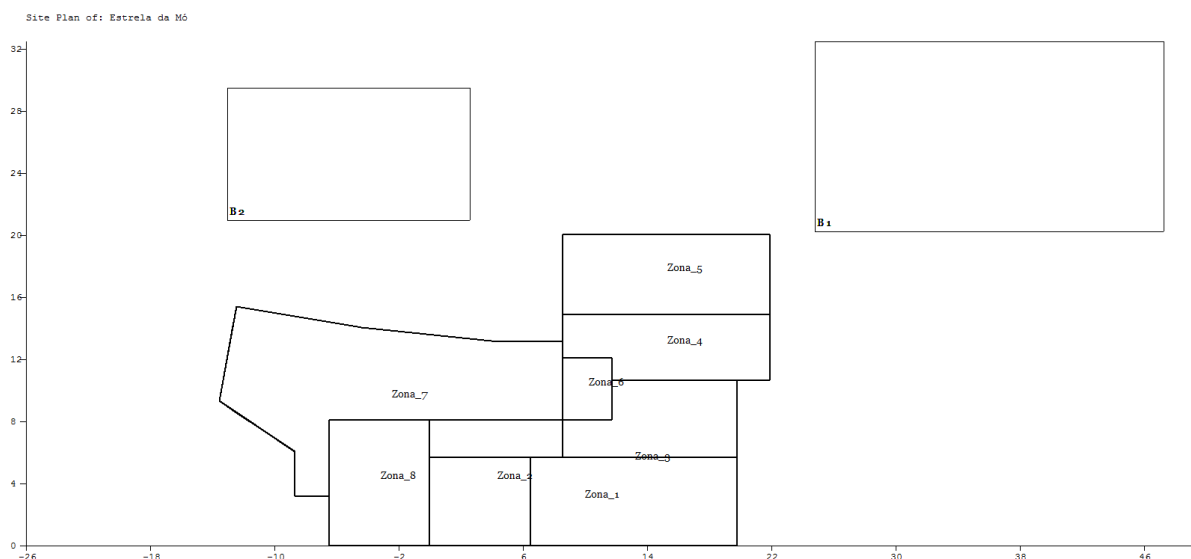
Vista em plano do modelo (divisão das zonas).
